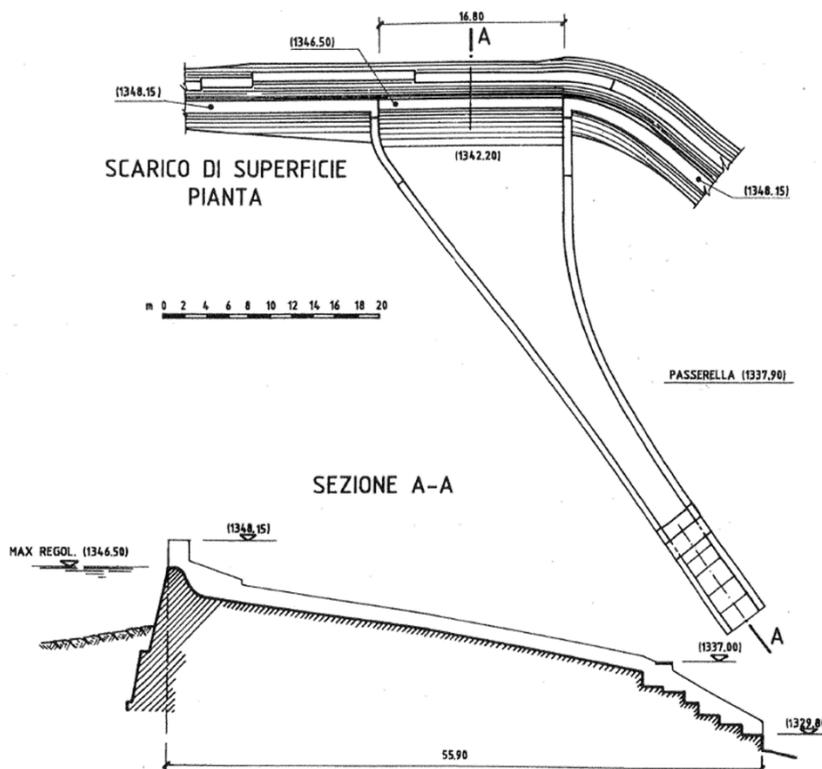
Scarico di superficie. In alto la planimetria e in basso il profilo longitudinale
